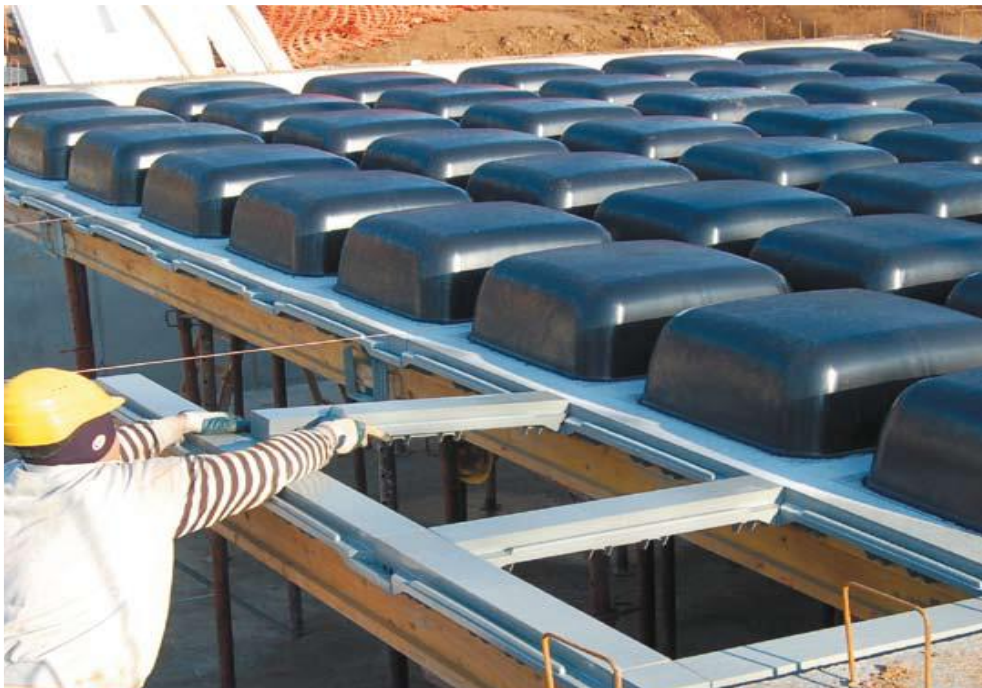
Влаштування опалубних форм для монолітного часторебристого перекриття
